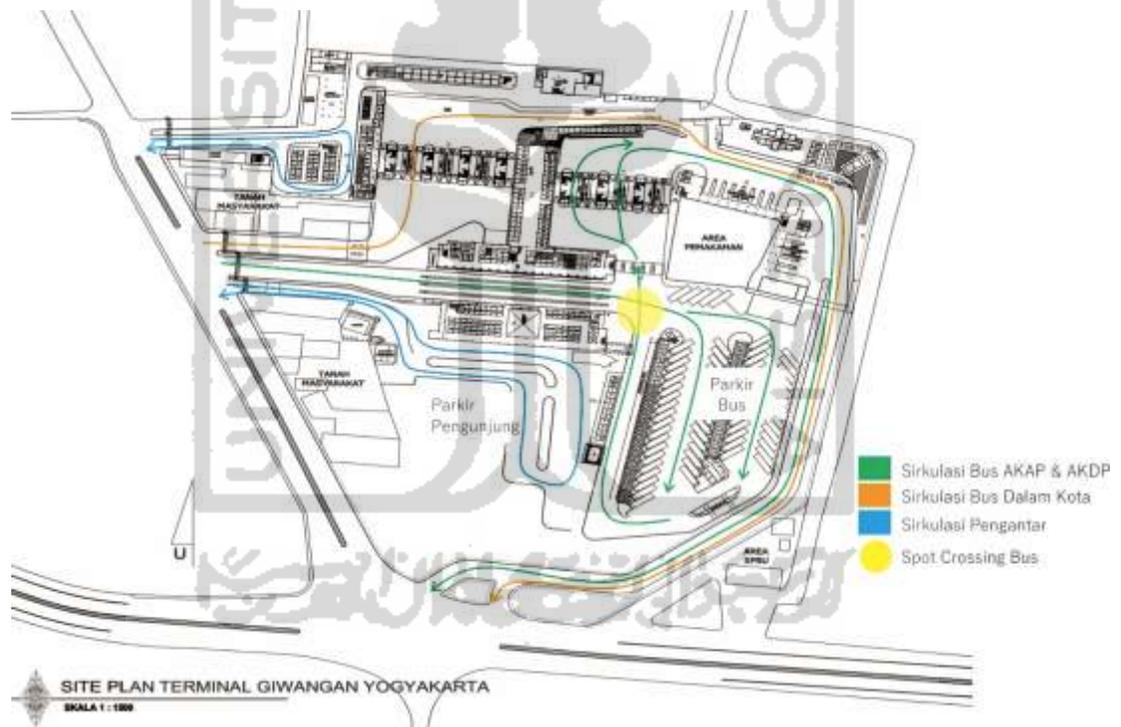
Layout Terminal Giwangan (Sumber: Dinas Perhubungan)
